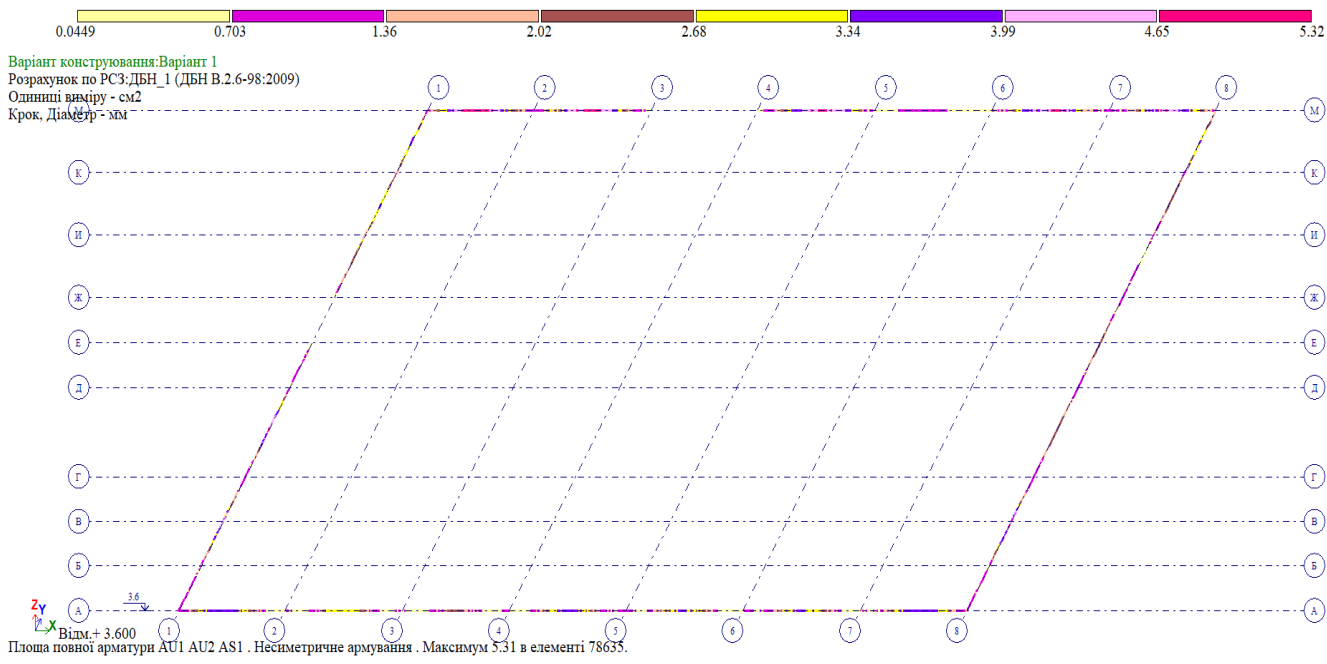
Площа робочої арматури у нижній грані балки Б-1
